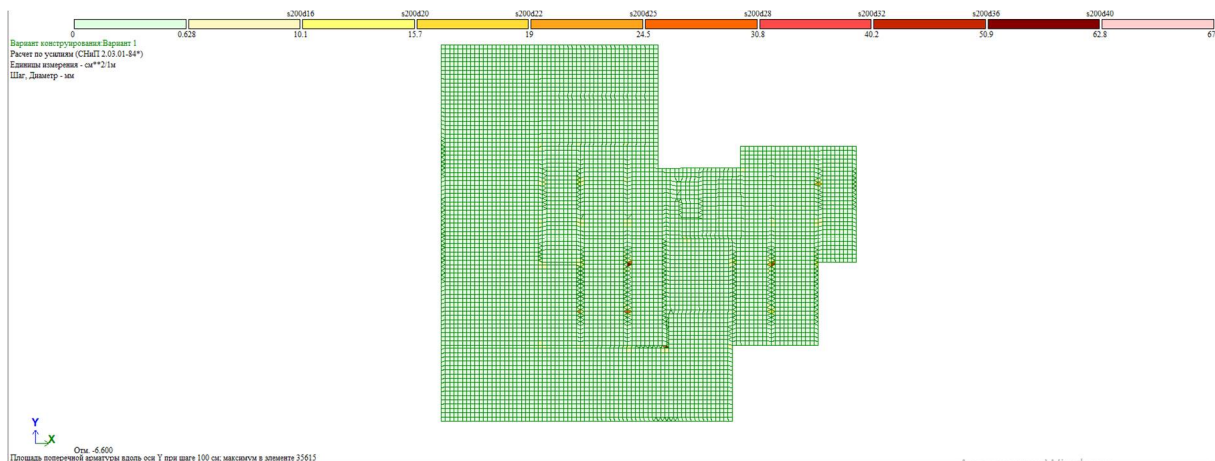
Мозаїка поперечного армування фундаментної плити товщиною 1,5 м по осі У
